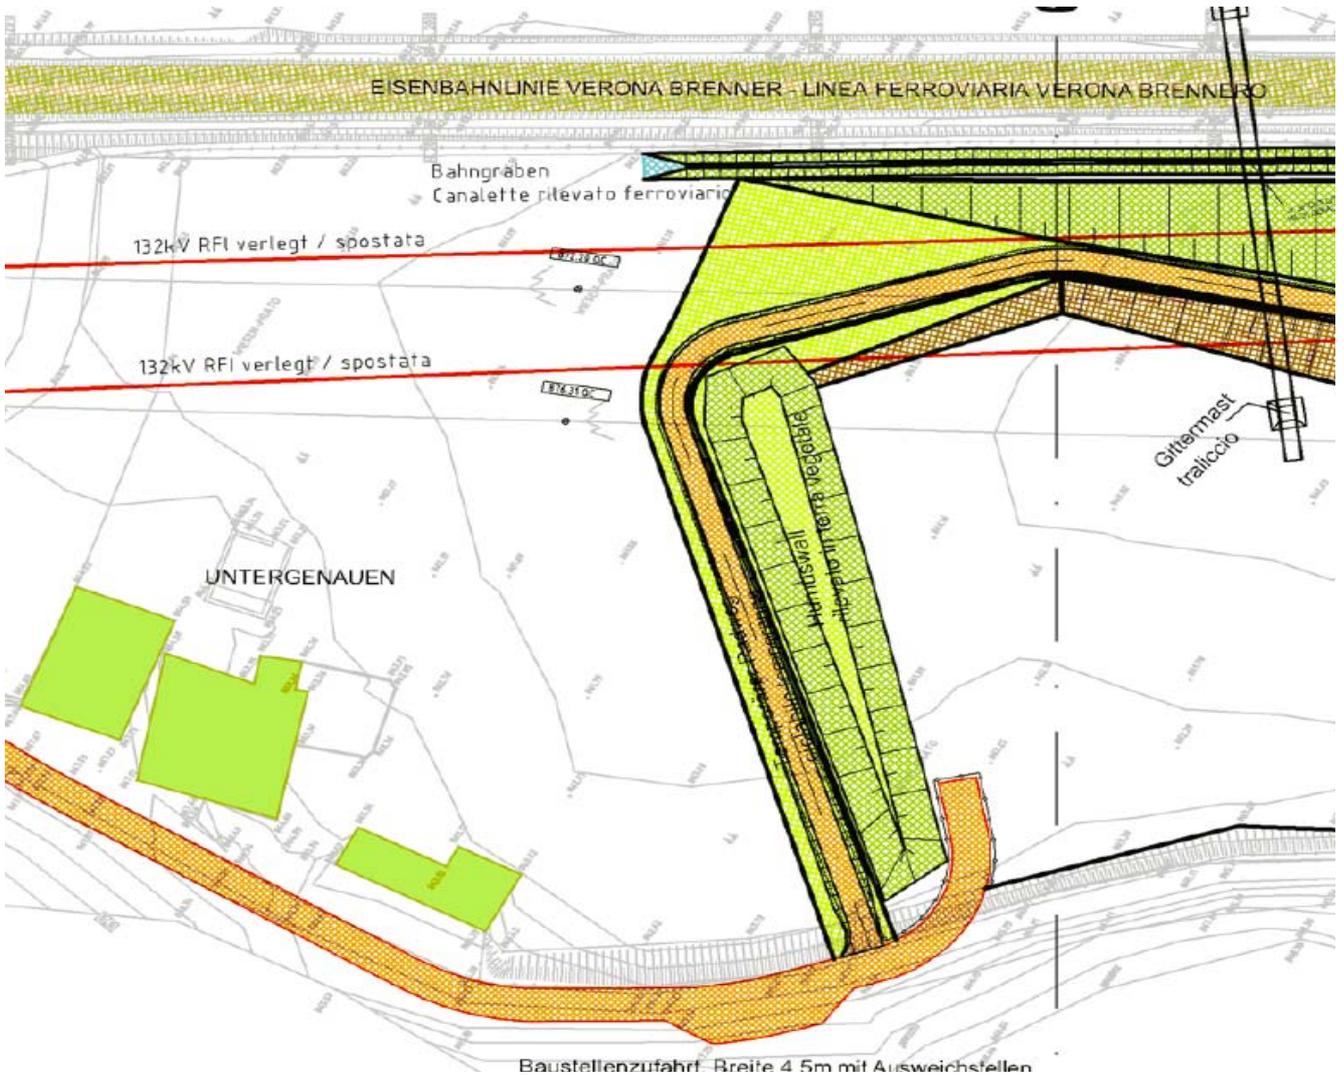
Detail Zwischenlager-Depot bei Baustelle Genauen
